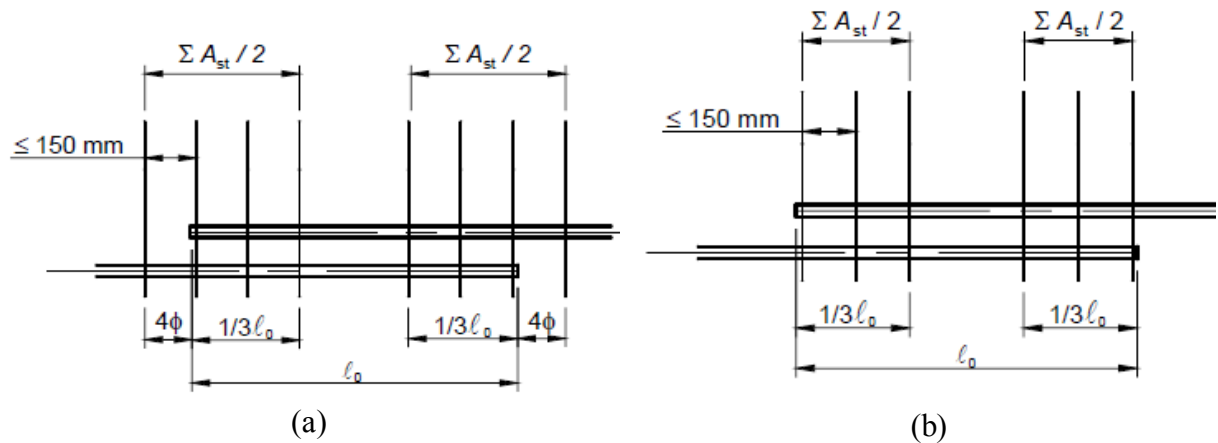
Disposição da armadura transversal nas emendas de barras (a) tracionadas e (b) comprimidas.
